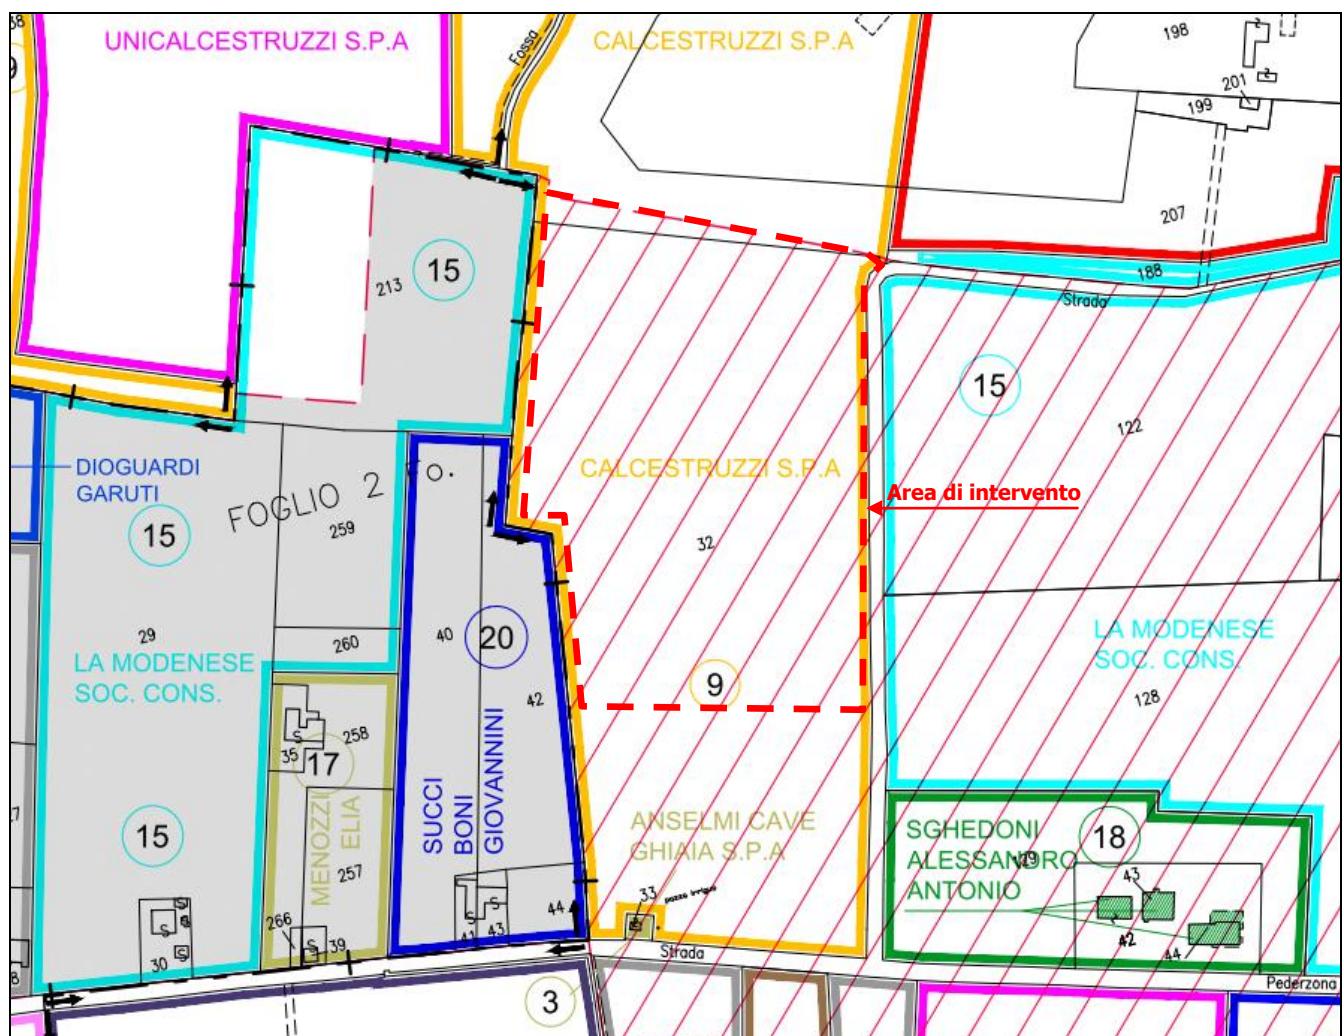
Planimetria catastale con individuazione delle proprietà - Estratto dalla tavola 2.2.c del PC
